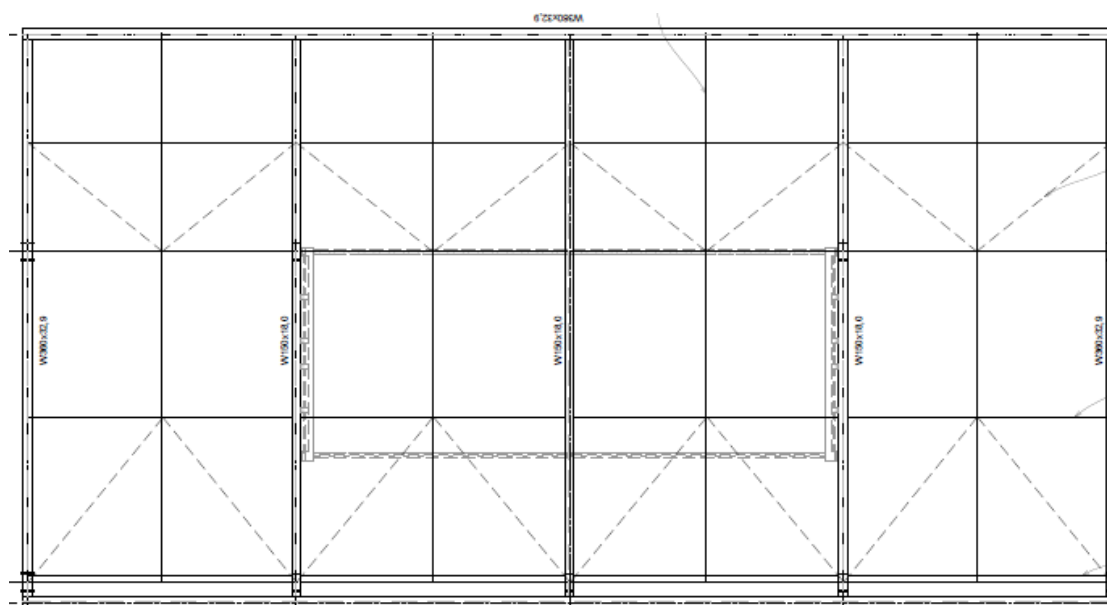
Planta de vigamento de cobertura – Anexos Comerciais
